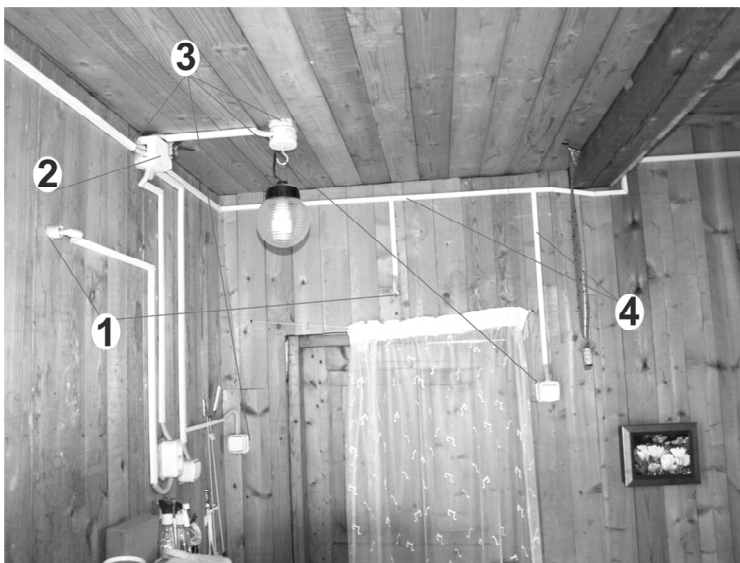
Фрагмент электропроводки в кабель-канале:
